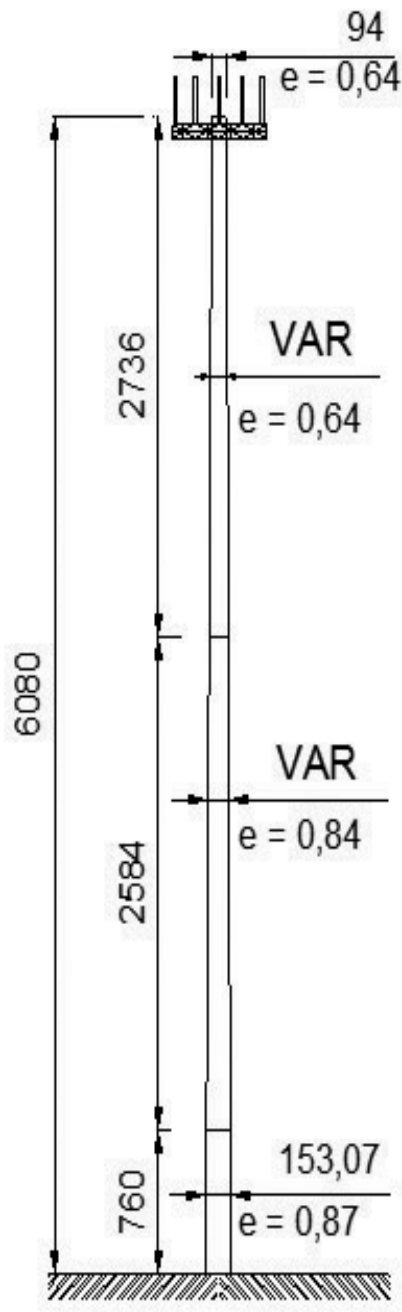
Estrutura 2: Geometria - Poste Metálico – 60,8 m - Medidas em centímetros.
